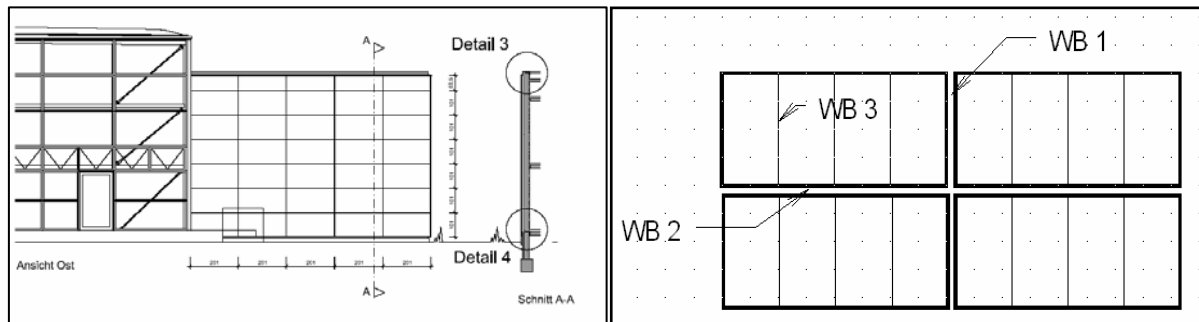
Fassadenplan Ost (Quelle: IGEL Institut für Gebäude+Energie+Licht Planung)
